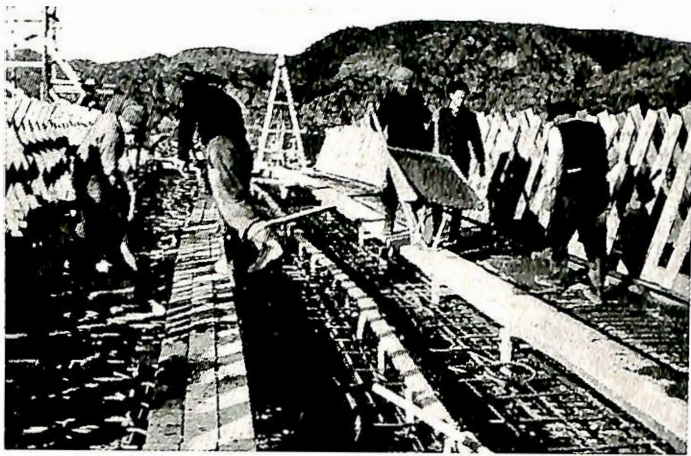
Støping av utkragerspennet på fastlandssiden.
